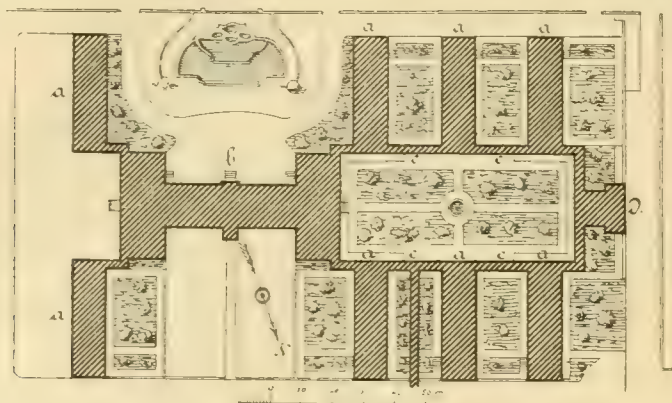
Neues Krankenhaus in Aßig. Lageplan.
